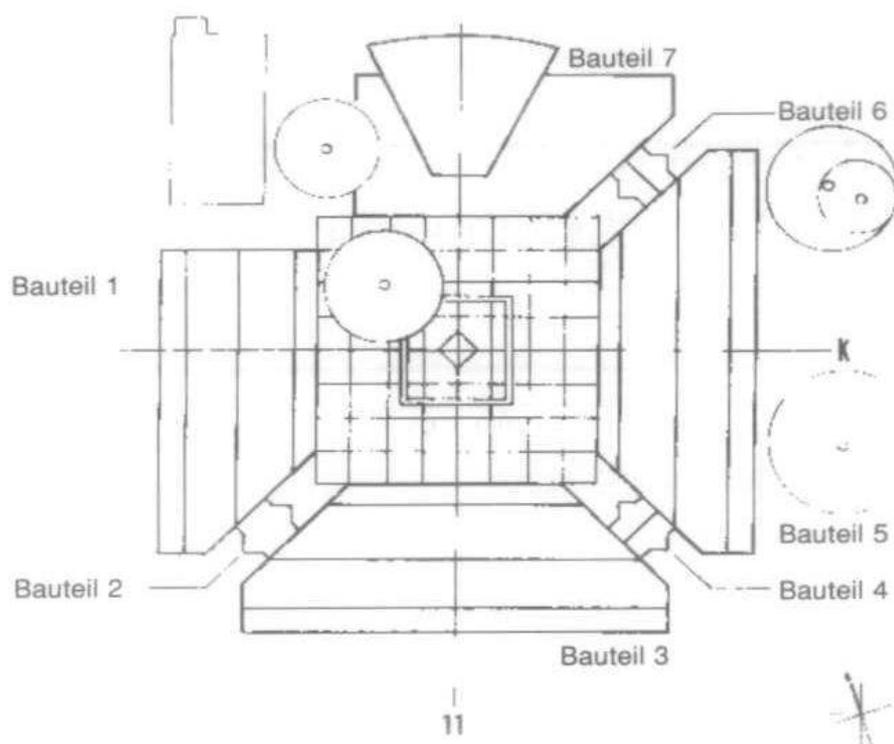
Grundriß (Fassadenschnitt Dachbereich) des Labor- und Hörsaalgebäudes der GhK am Standort Witzenhausen (Bauteile 1, 3 und 5: Laborgebäude; Bauteile 2, 4 und 6: Verbindungsbauteile; Bauteil 7: Hörsaalgebäude mit Seminarräumen. (Quelle: Staatsbauamt)
